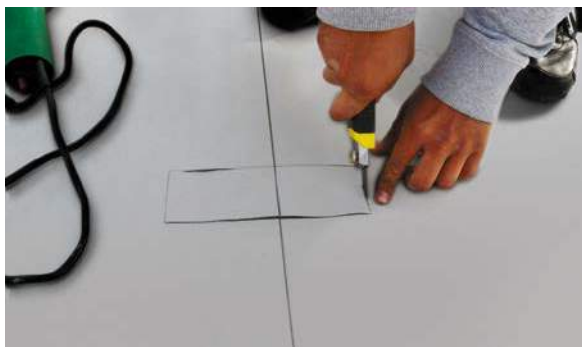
Вырезание тестовой полоски из сварного шва
